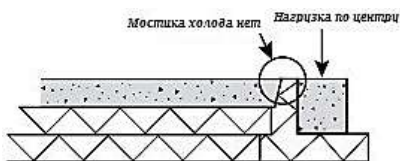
Шведський фундамент Супергрунд (Supergrund) або УШП 2.0.
